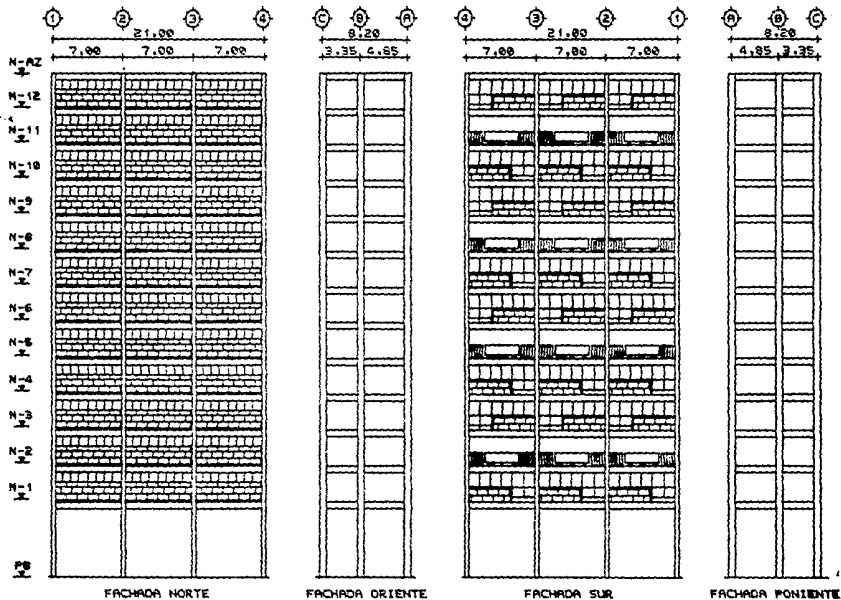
FACHADAS DE EDIFICIO TIPO "B"
